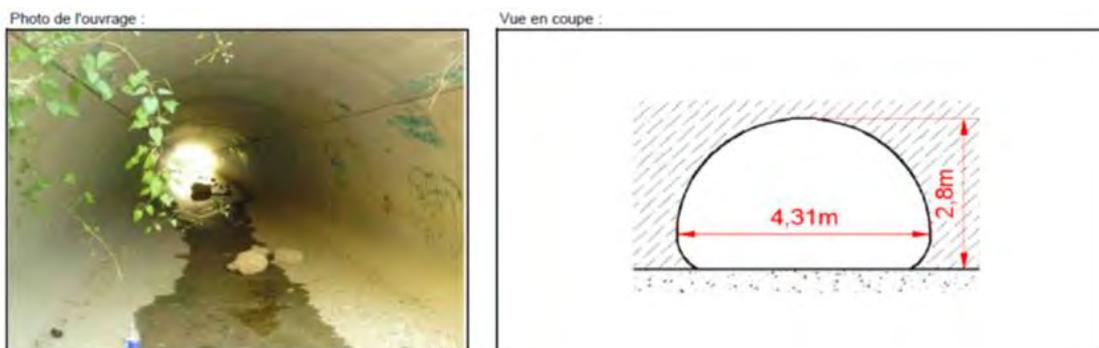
OUVRAGE ET COUPE DE L'OUVRAGE DE FRANCHISSEMENT DE LA RN109
